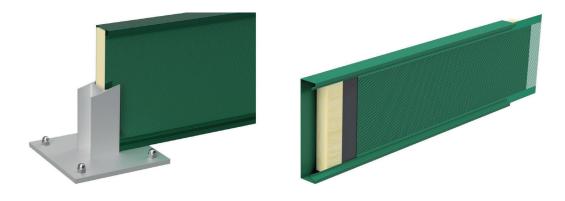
Detalles de pantallas acústicas metálicas sin tapas laterales.
